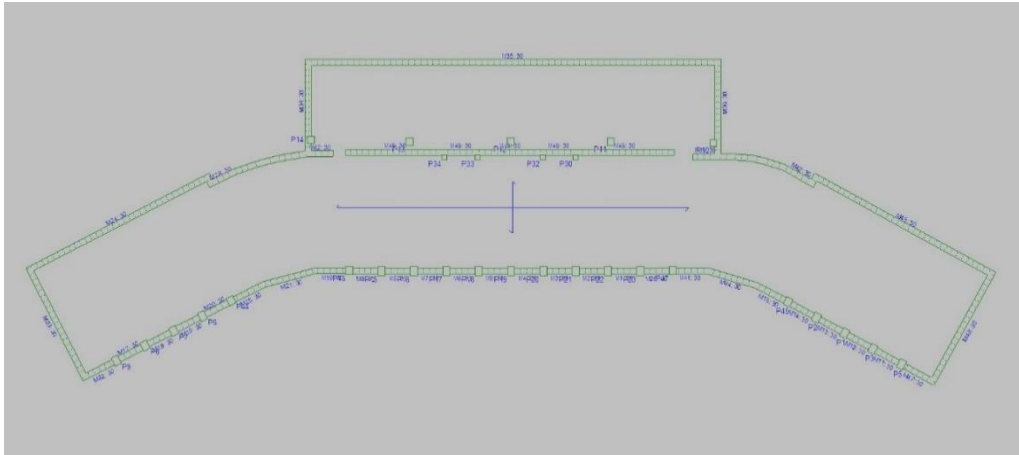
Planta cubierta del modelo de 5 plantas simplificado
